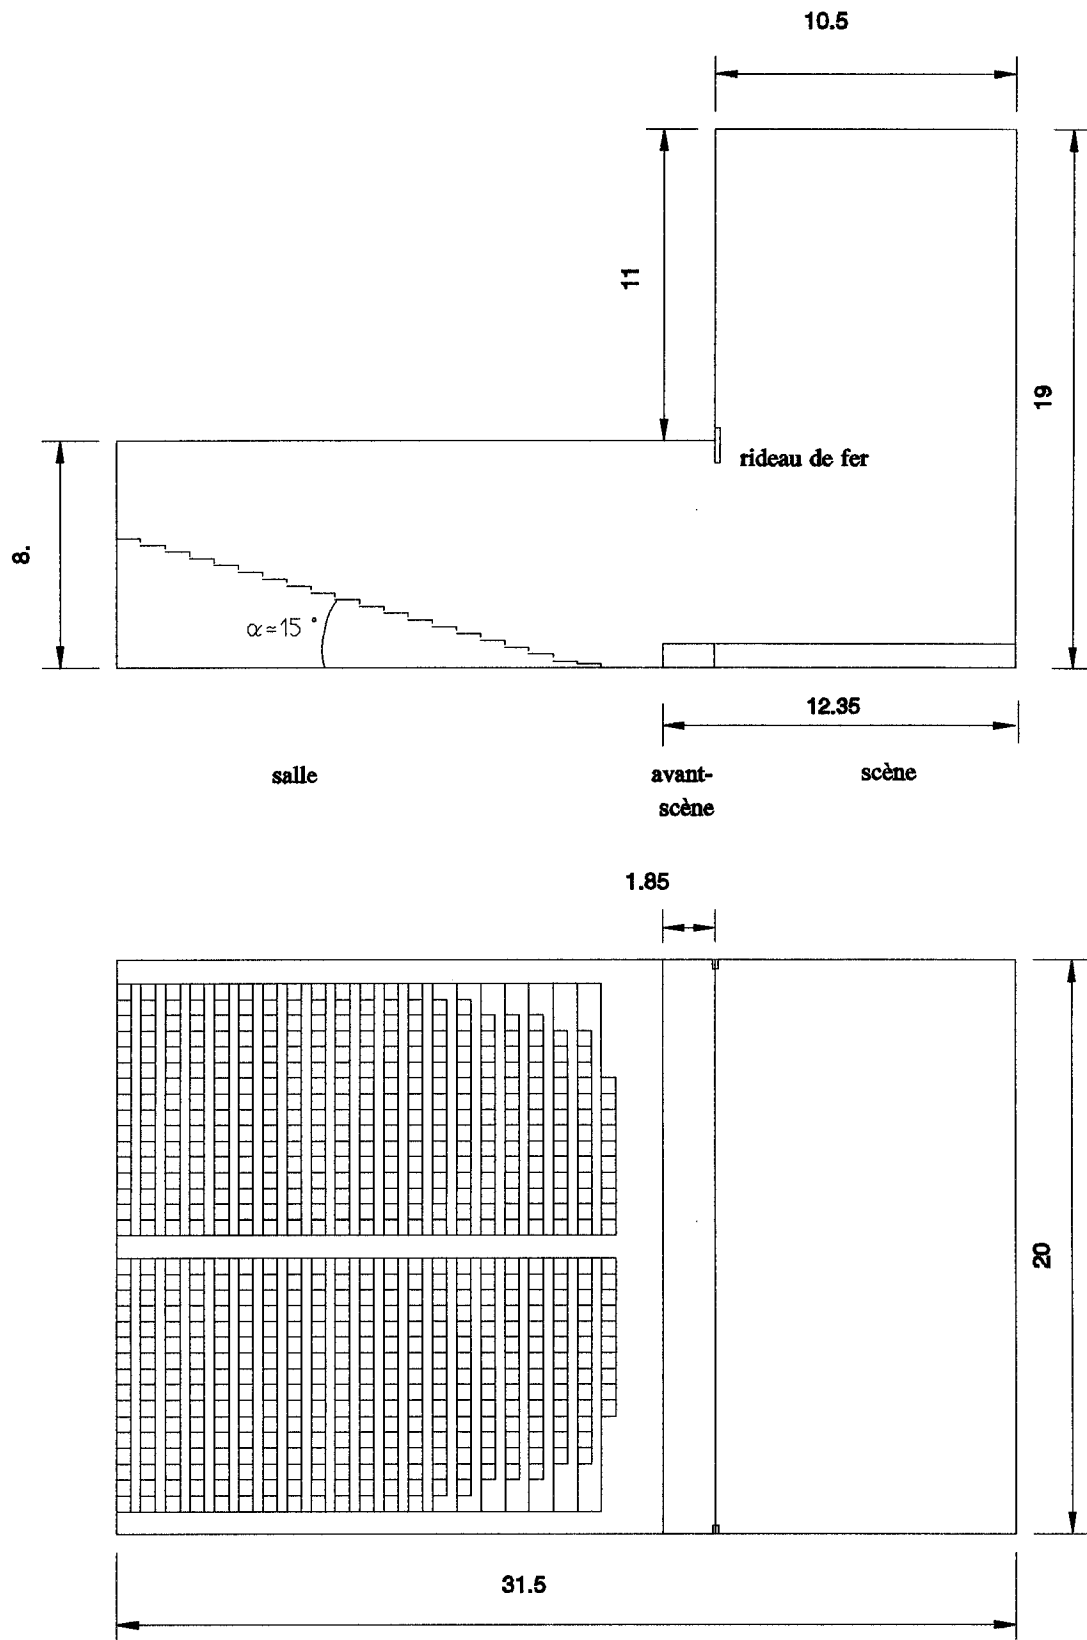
coupes verticale et horizontale de la grande salle du Théâtre de la Place, d'après plans
